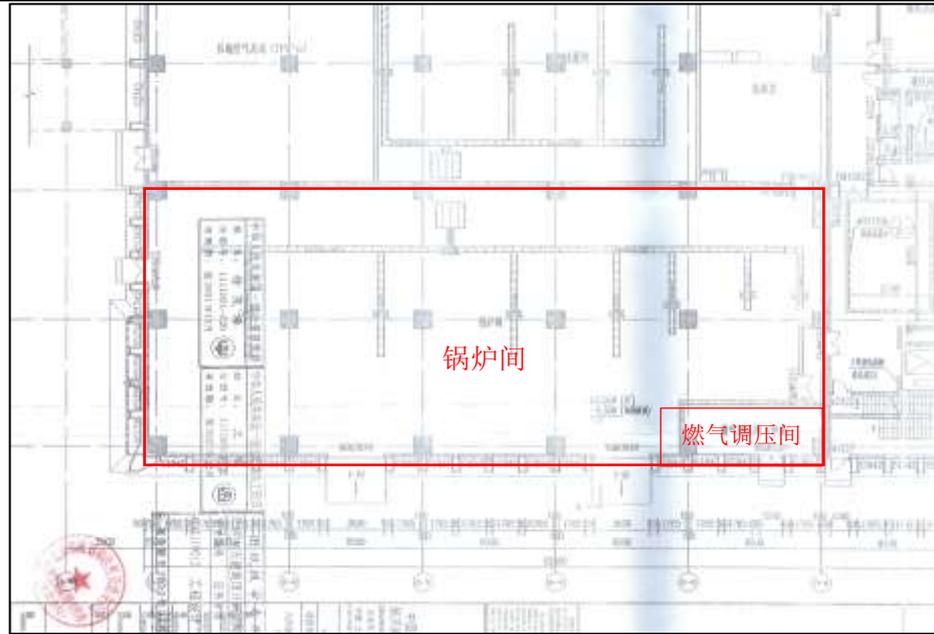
10#厂房一层平面图中锅炉房及燃气调压间位置
